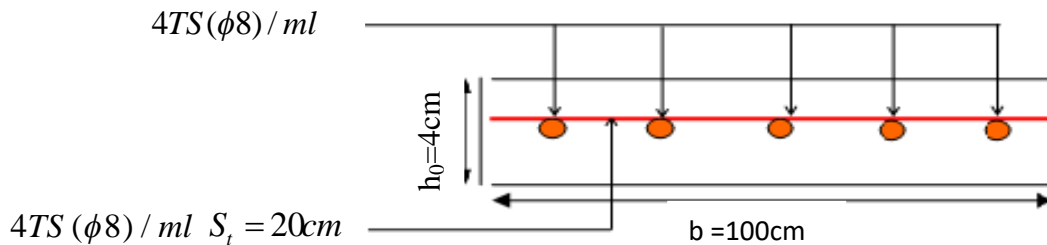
Schéma de ferrailage de la dalle de compression.
